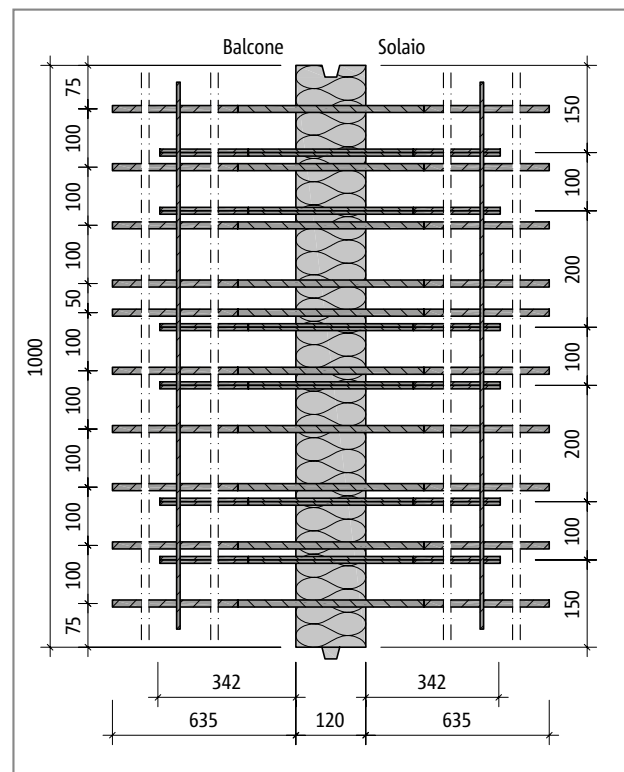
Schöck Isokorb® tipo DXT70-VV6: pianta
